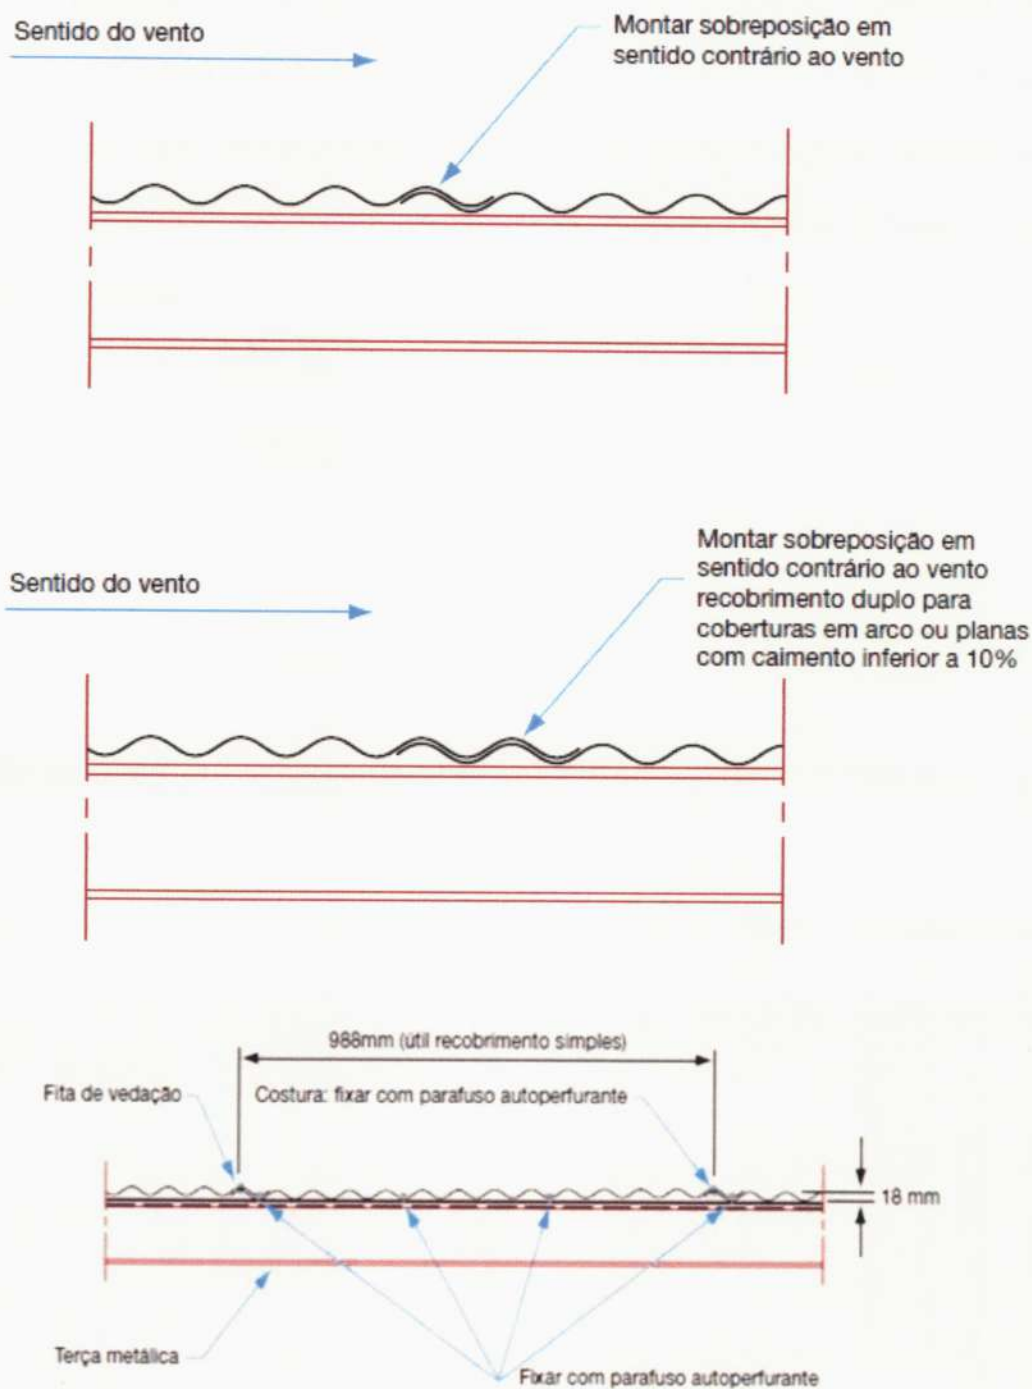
Montagem do telhado – telhas onduladas (Fonte: ABCEM, 2009)
